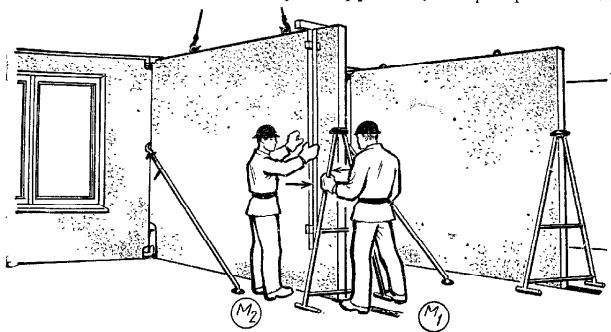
Крепление панели внутренней стены треугольной стойкой
